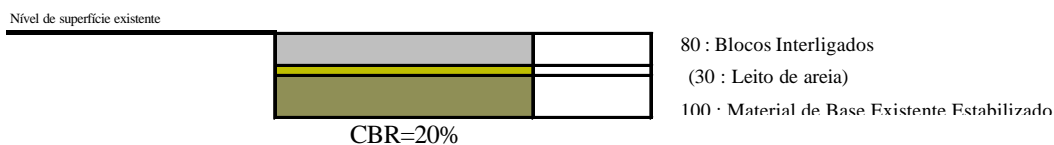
Estruturas de Pavimento Propostas (2)
